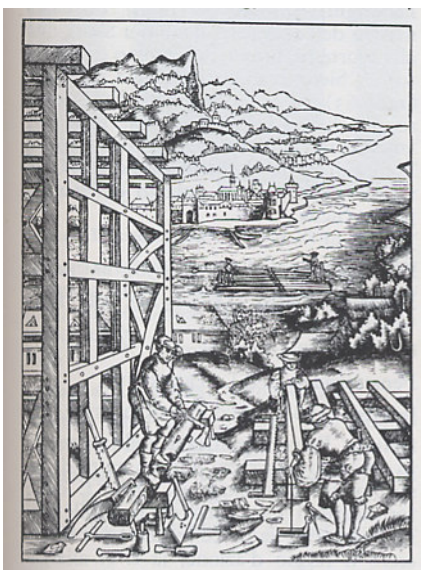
Costruzione in Fachwerk, 1531.
